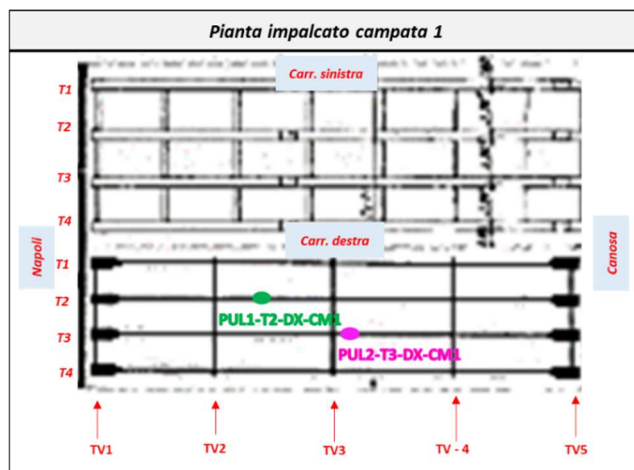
Ubicazione prove in pianta e documentazione fotografica – Prove di pull out
